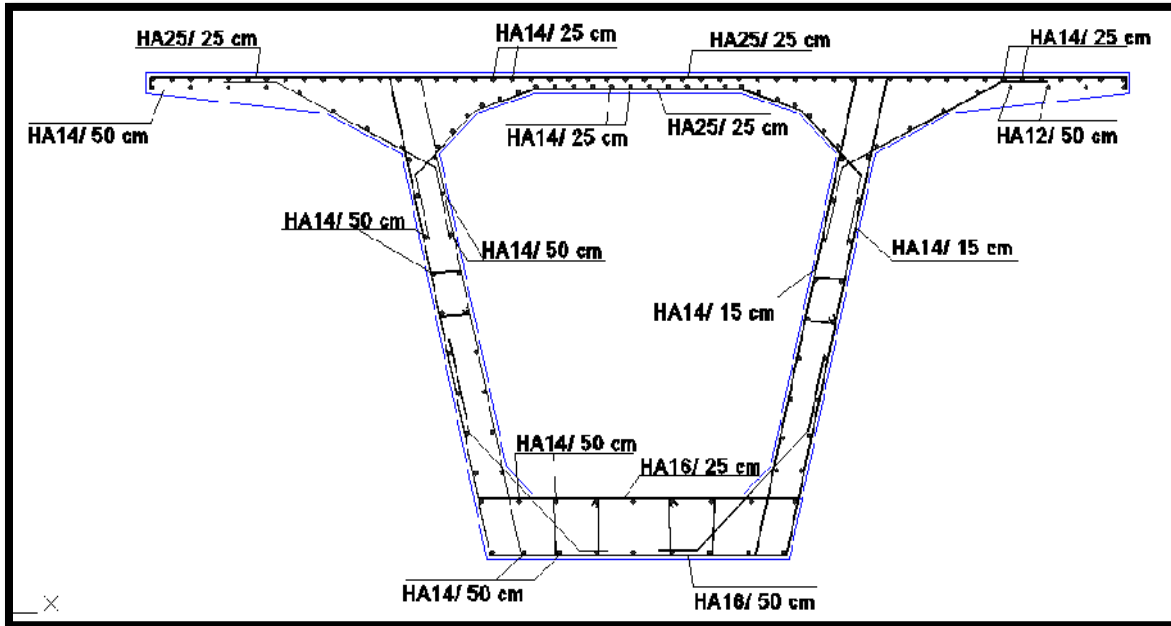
Ferrailage du voussoir près de la pile.
